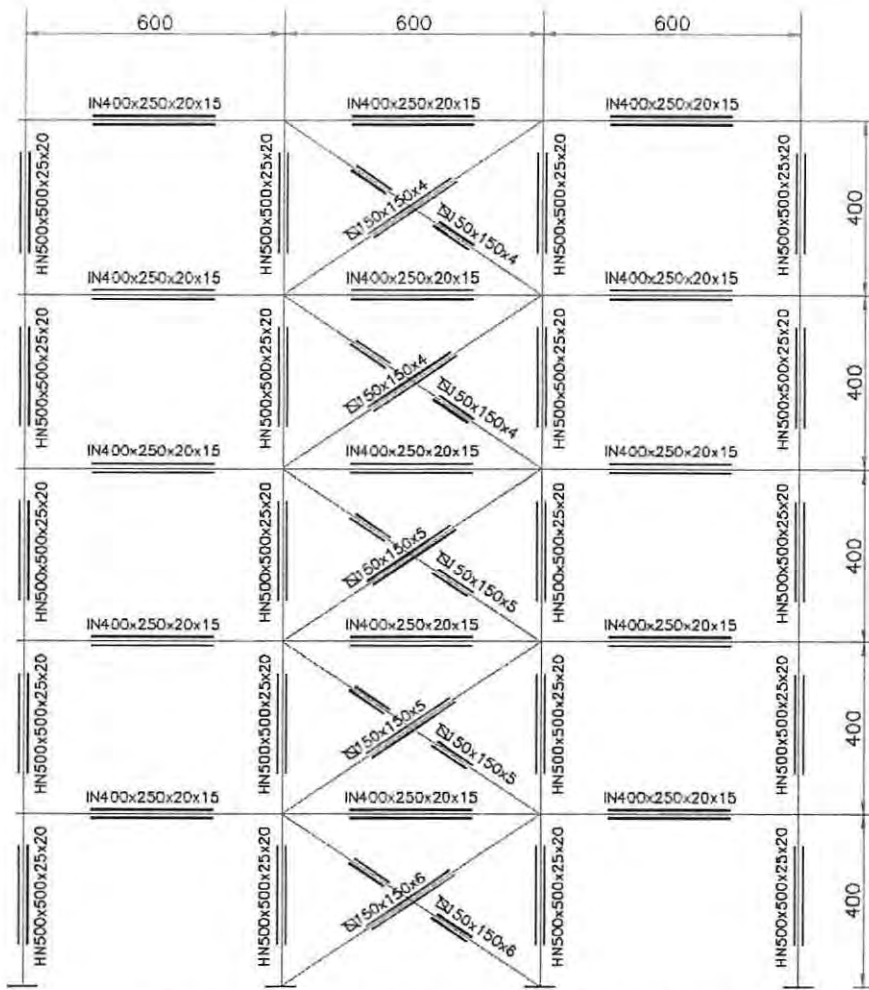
Elevación de los ejes 1, 4, A y D del edificio original.
